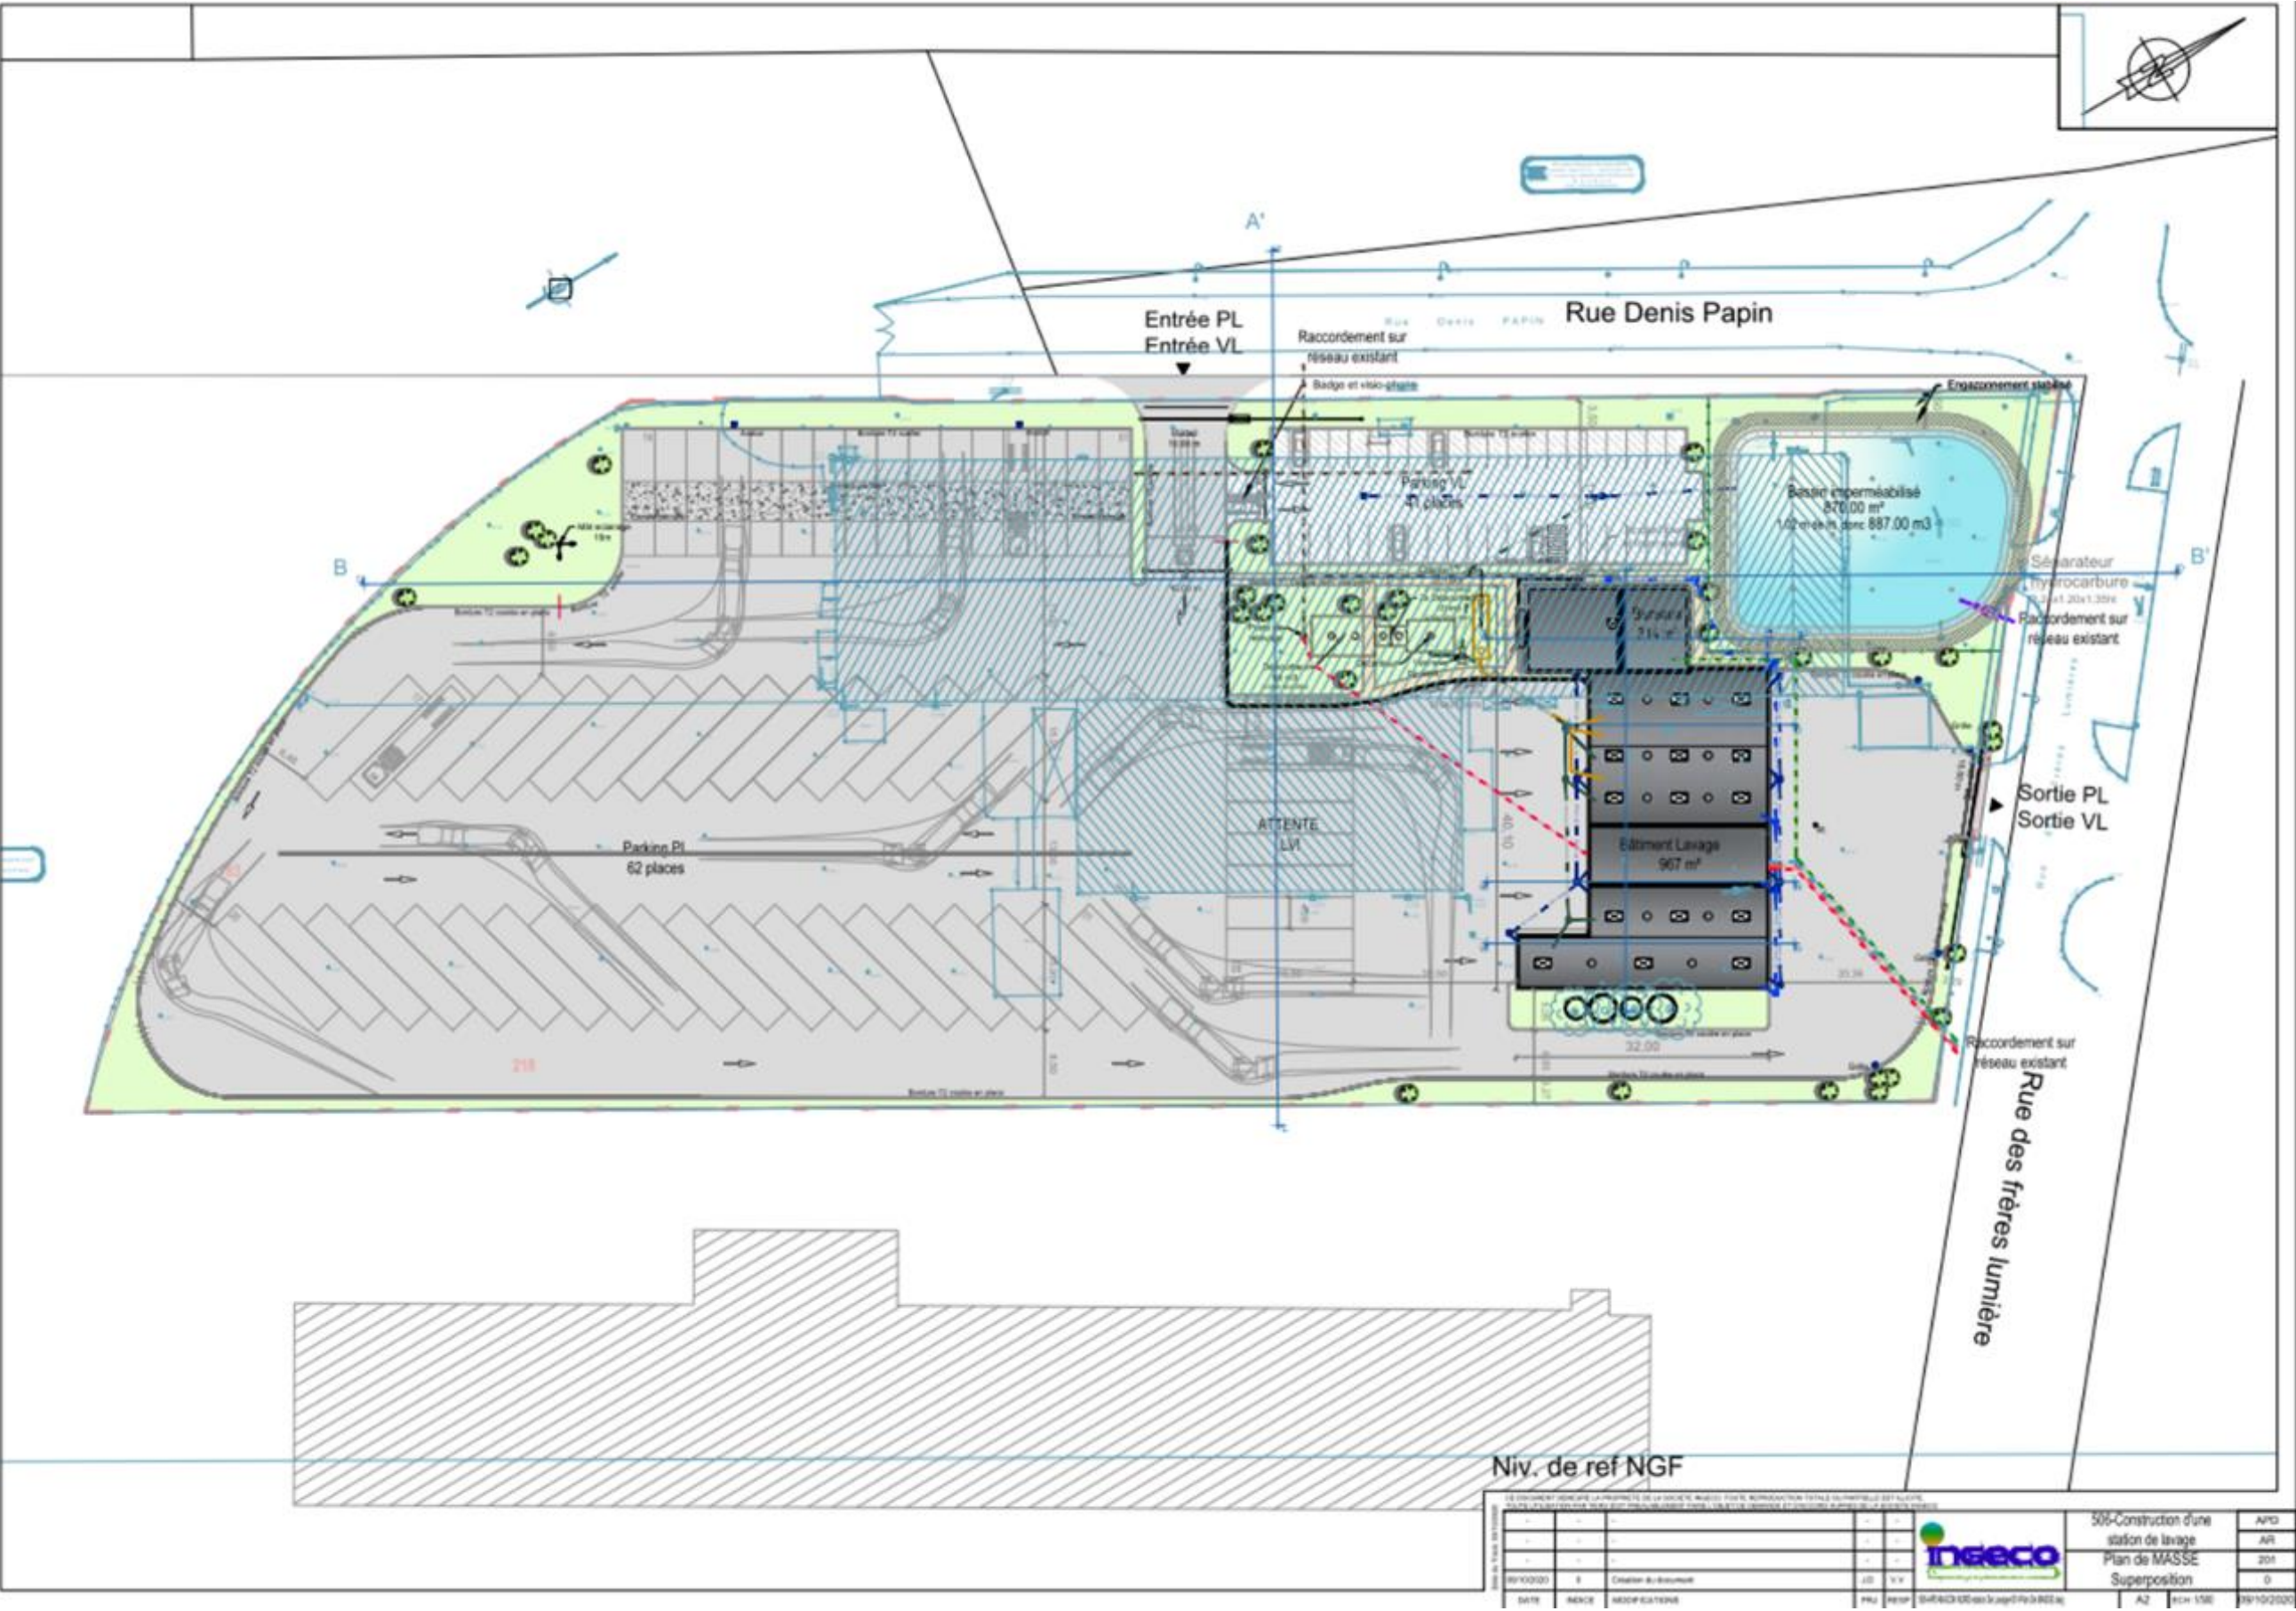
PLAN MASSE DU PROJET (SOURCE : M. ALAINE)
